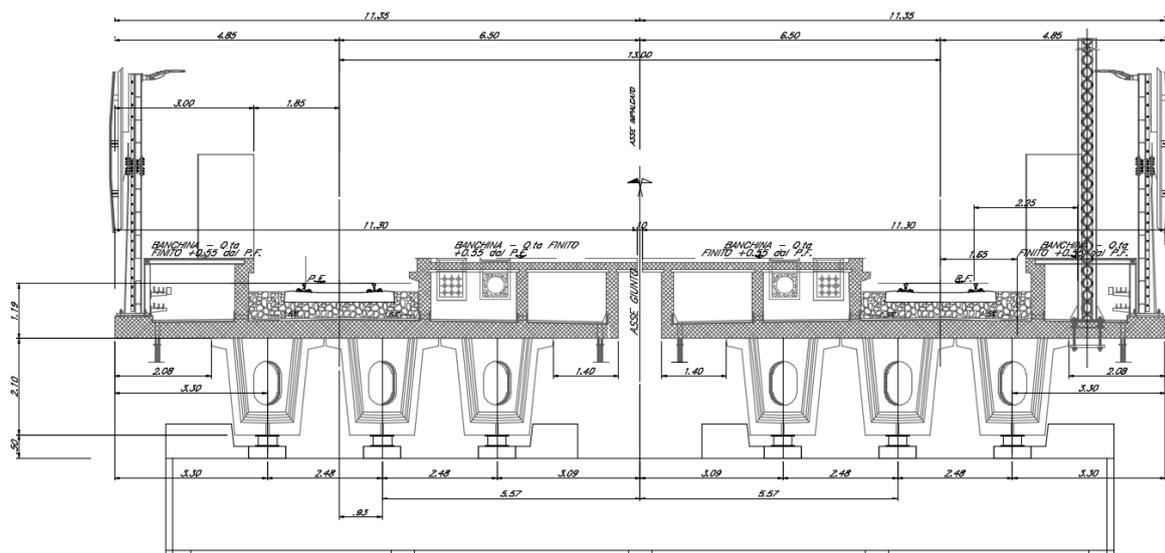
Sezione trasversale in corrispondenza della pila P3
